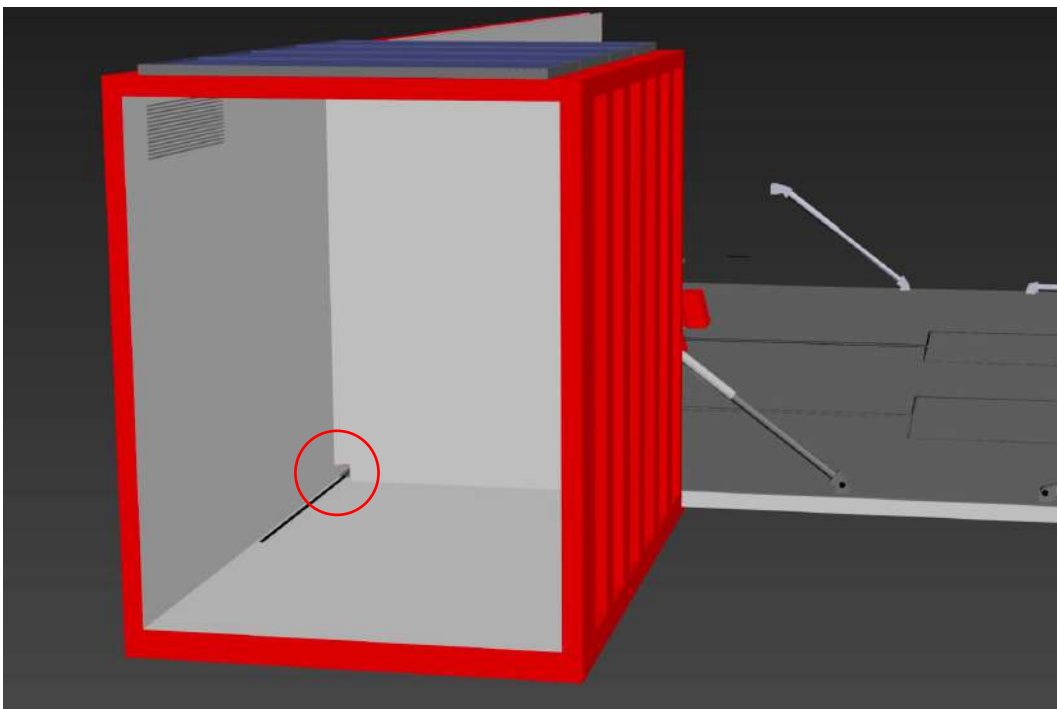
Render detalle entrada y salida de cables del container “Fuente: Elaboración propia”
